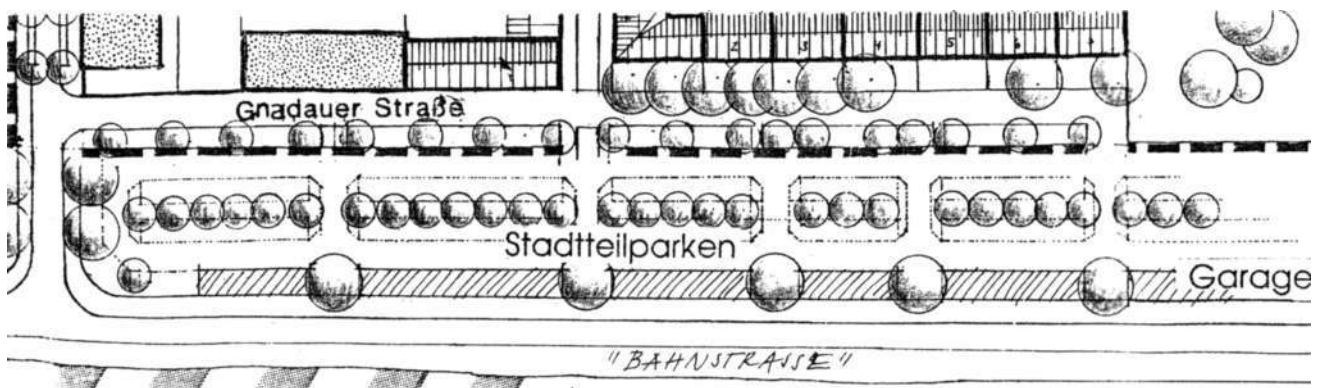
Neue Bahnstraße, Anbindung an die Warschauer Straße, Ausschnitt Gestaltungskonzept Städtebaulicher Rahmenplan
